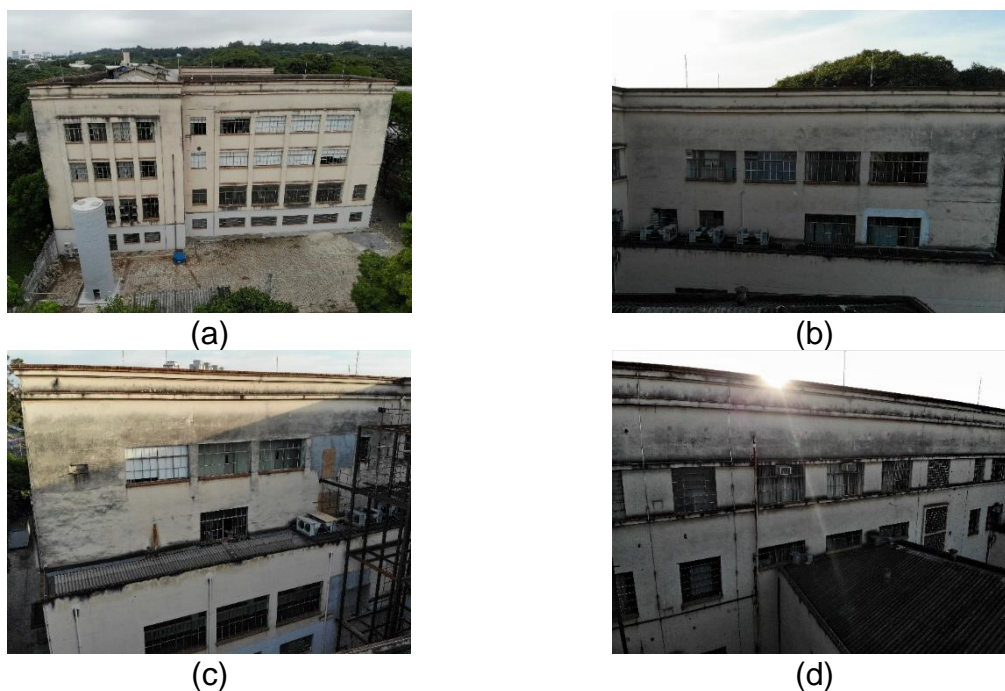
Fotos obtidas com o drone: (a) Fachada noroeste-1; (b) fachada noroeste-2; (c) fachada sudeste e (d) fachada sudoeste.
